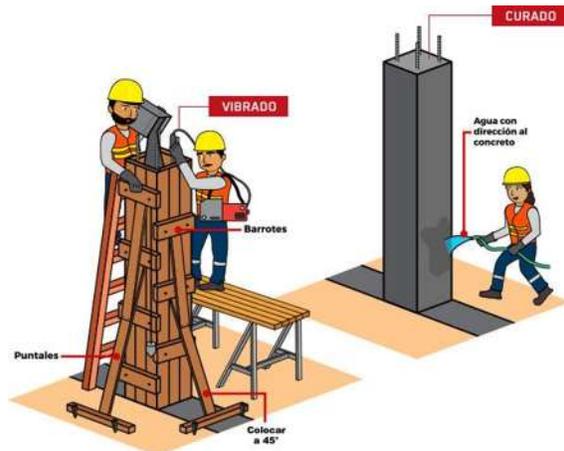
Proceso de vertido de concreto para columnas. Tomado de construyebien.com. (Consultado el 14/11/2020).
